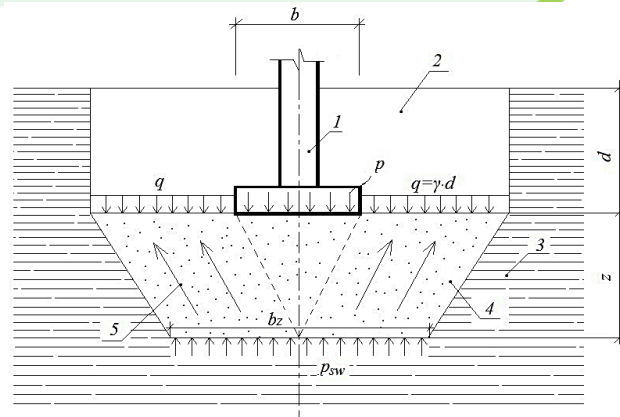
Схема компенсирующей песчаной подушки в основании ленточного фундамента и ее взаимодействия с набухающим глинистым грунтом: 1 – ленточный фундамент; 2 – грунт обратной засыпки; 3 – набухающий глинистый грунт; 4 – песчаная компенсирующая подушка; 5 – направление выпирания песка; p – давление по подошве фундамента; $q = \gamma \cdot d$ – давление от собственного веса грунта на отметке подошвы фундамента; p_{sw} – давление набухания грунта; b – ширина подошвы фундамента; b_z – ширина компенсирующей подушки
